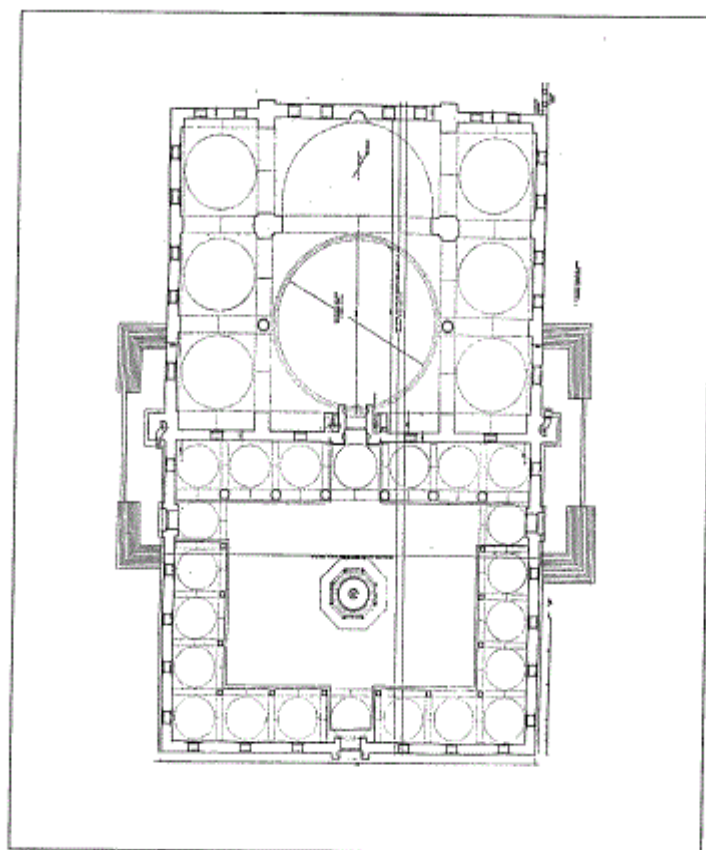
مسقط أفقي لمسجد إبراهيم Basçi في بورصة (أوبروسه) (عن : كوران) .
